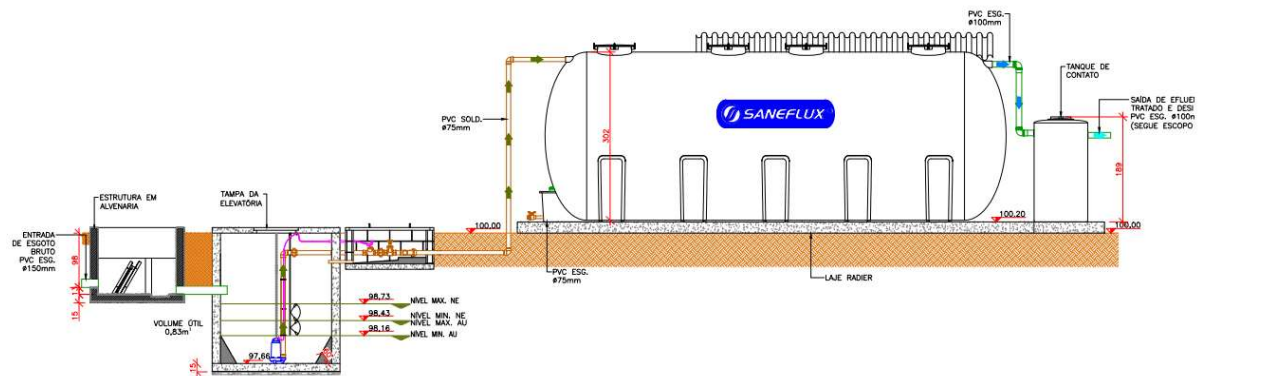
Planta de Corte da Estação de Tratamento de Esgoto Saneflux©
